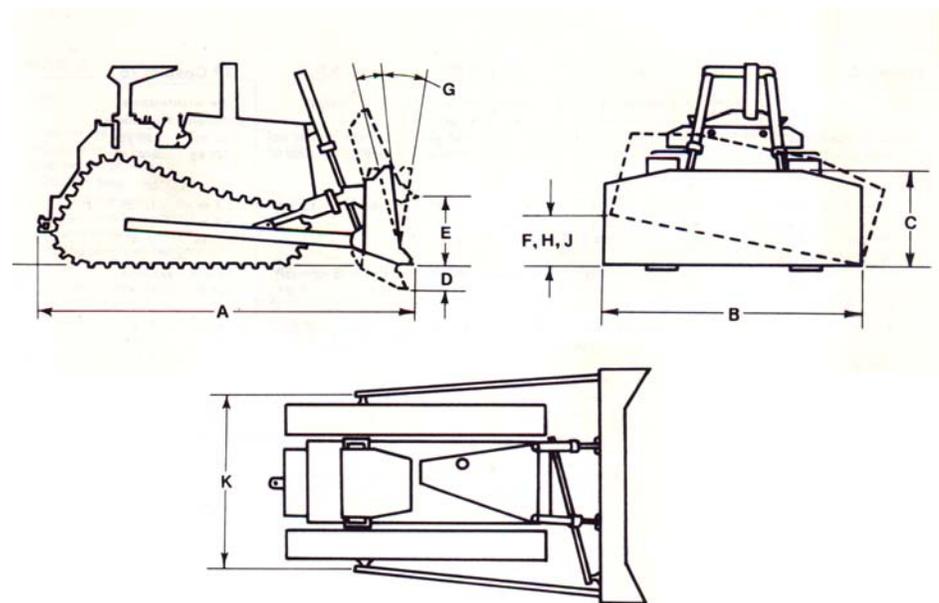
Dimensiones del tractor con la hoja topadora (7)
